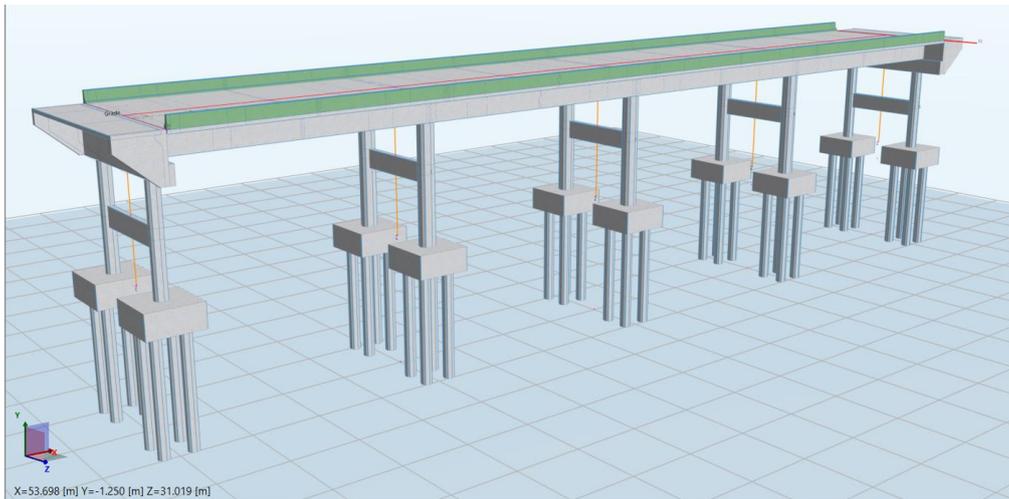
Modelo tridimensional da ponte finalizado no Allplan Bridge 2024.
